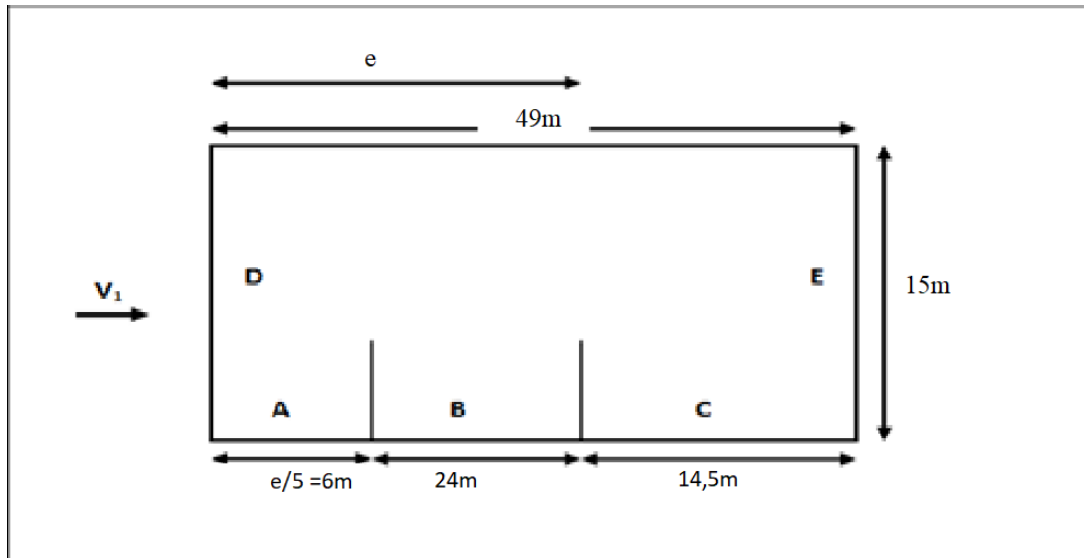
Vue en plan des zones de pression sur les parois verticales (Sens V_1)
